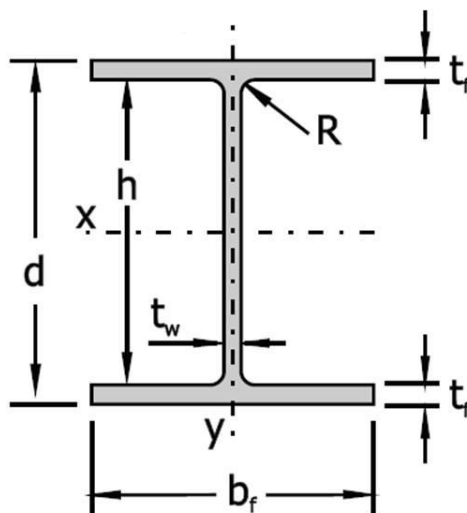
Exemplo de uma seção transversal de um perfil laminado.
